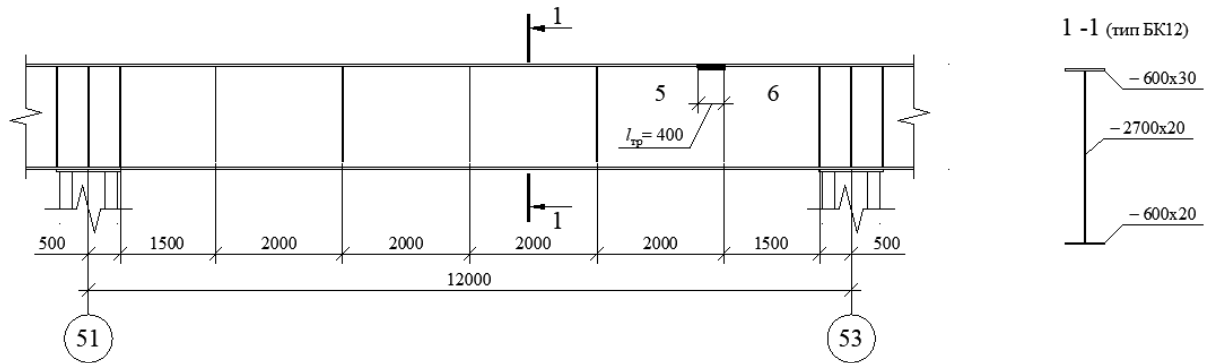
Схема поврежденной подкрановой балки №1
